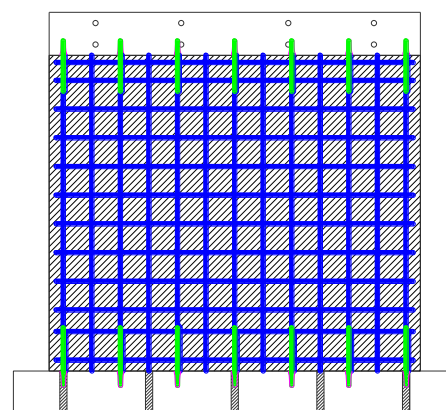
Agrietamiento de muro de albañilería confinada con ladrillos sólido artesanal en la distorsión 1/400.
